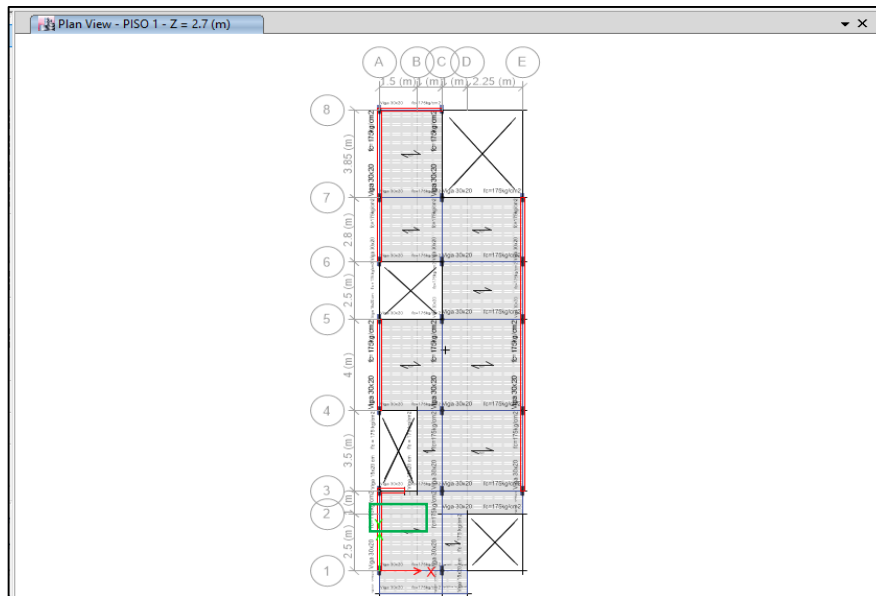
Vista en planta de la vivienda 1 reforzada con placa de concreto armado. Fuente: propia.
